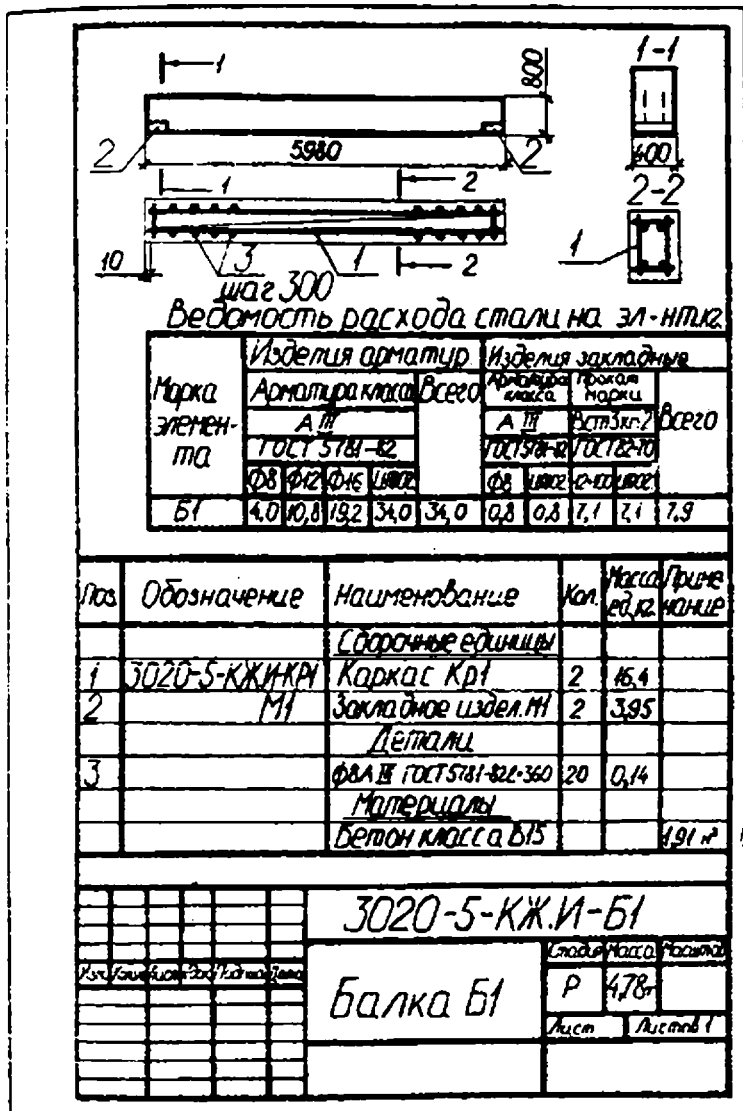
Пример выполнения рабочего чертежа железобетонной балки Б1 (индивидуальное изделие)
